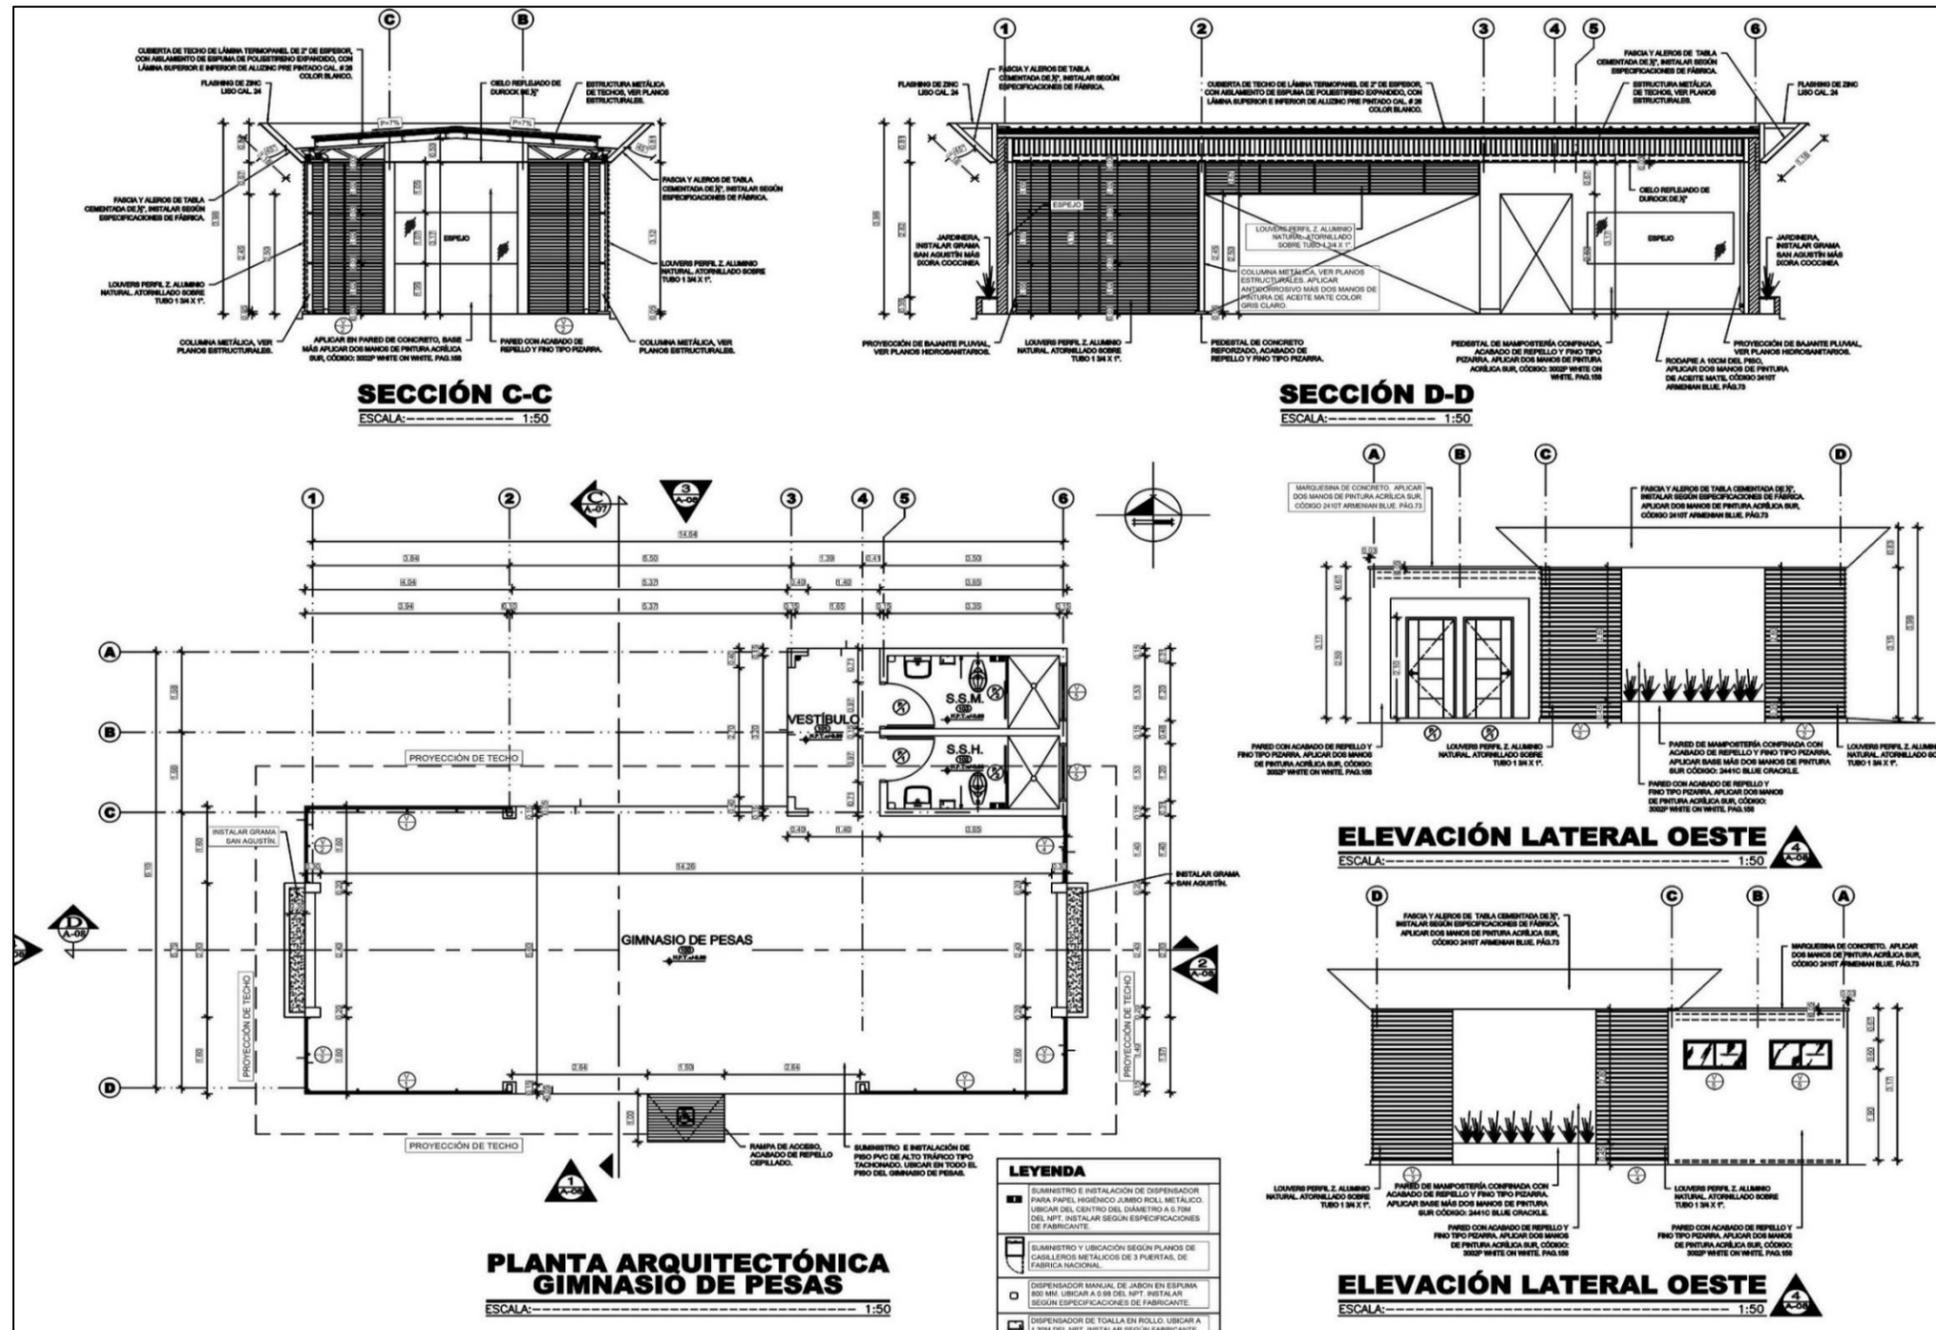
Planta Arquitectónica, Elevaciones y Secciones de Gimnasio de Pesas
